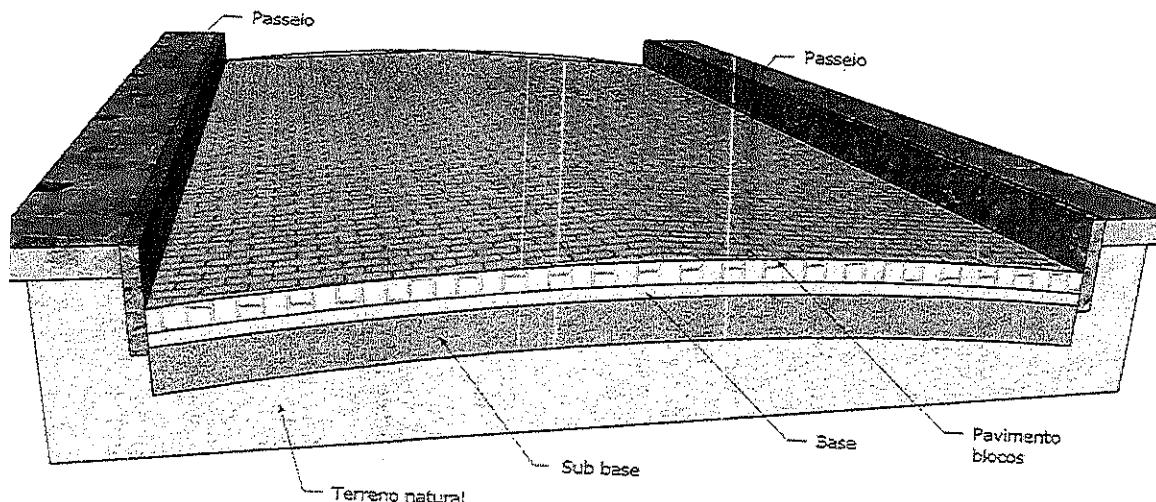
Desenho esquemático do perfil transversal da pavimentação
